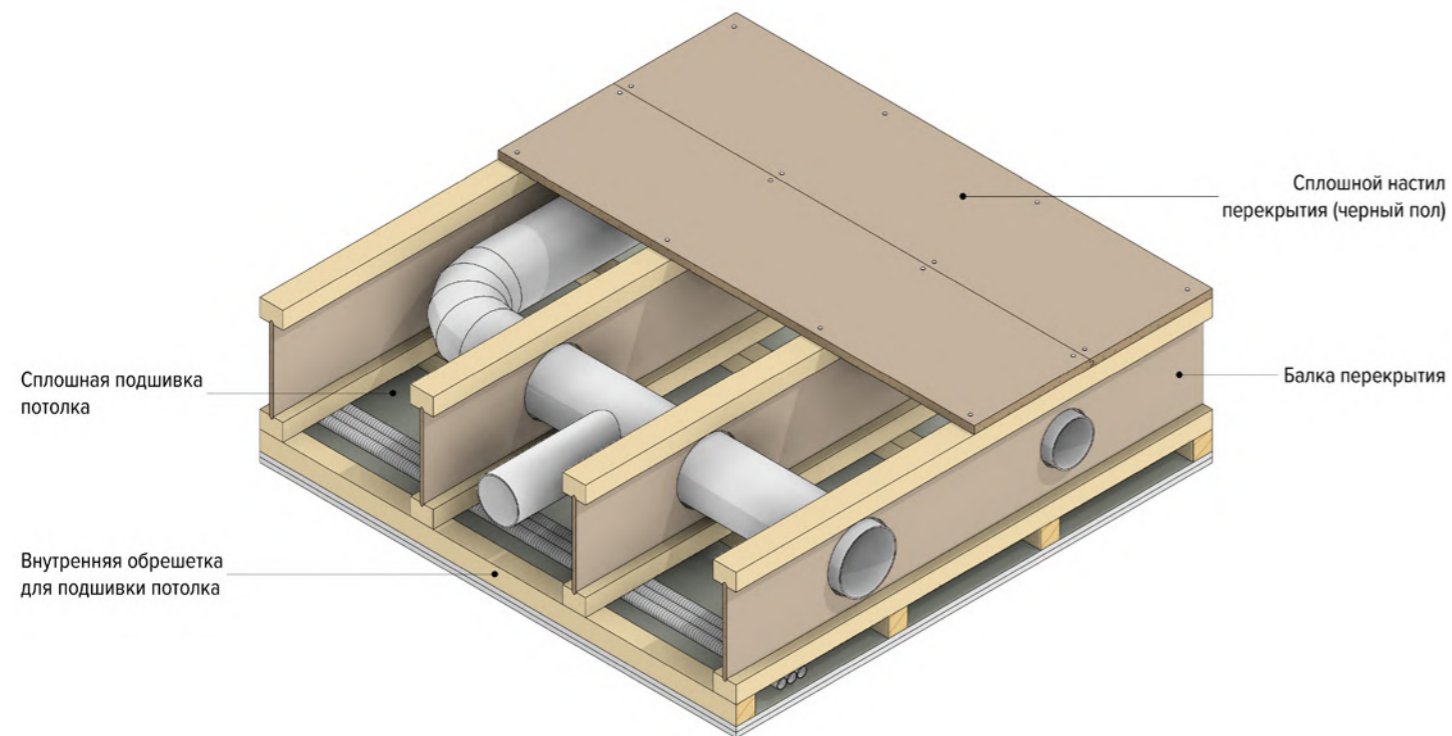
Основные конструктивные слои каркаса межэтажного перекрытия с применением двутавровых балок
